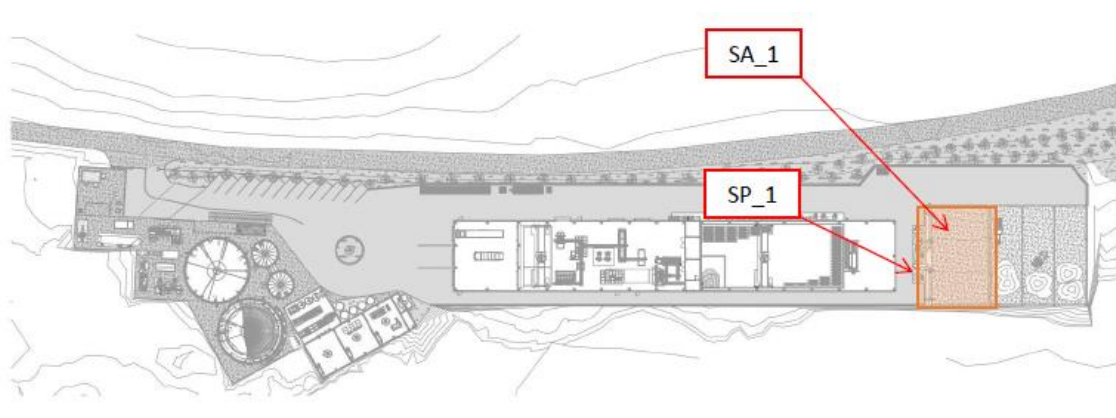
Planimetria con individuazione della sorgente emissiva da biofiltro e essiccatore
